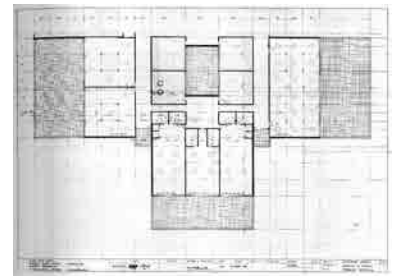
Planta de la zona de talleres del Centro de Universidades Laborales de Almería. En la imagen se aprecia el trazado de la malla de cuadrados de 4 m de lado empleada para el dimensionado del proyecto.
